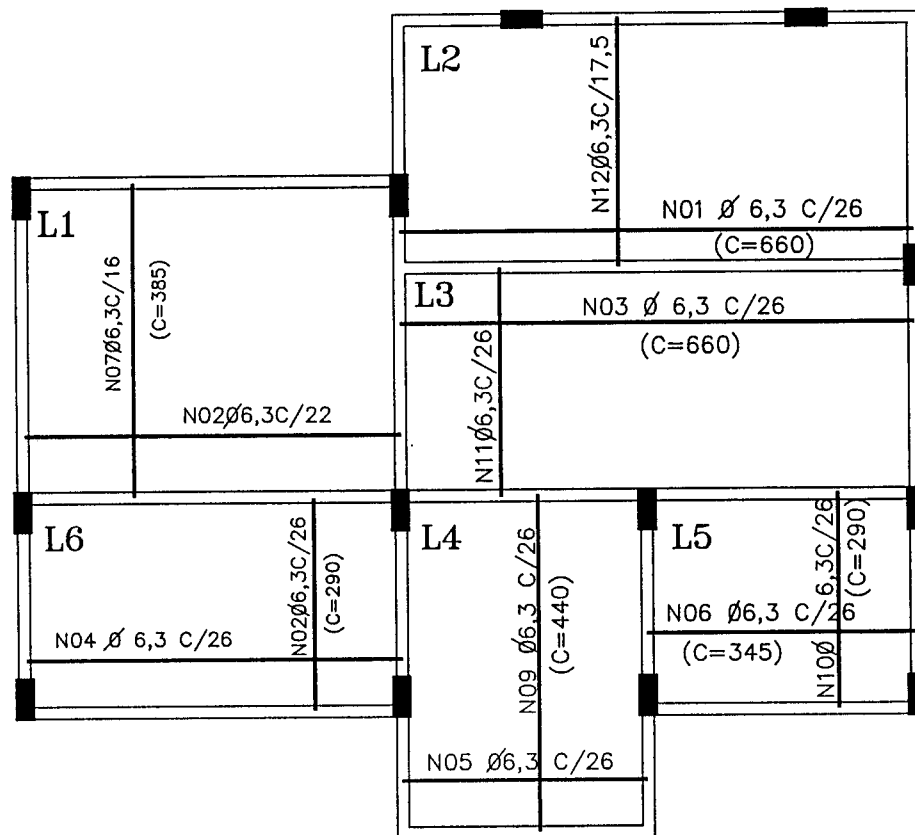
DESENHO ESQUEMÁTICO DAS ARMADURAS - ESTRUTURA 1.2
